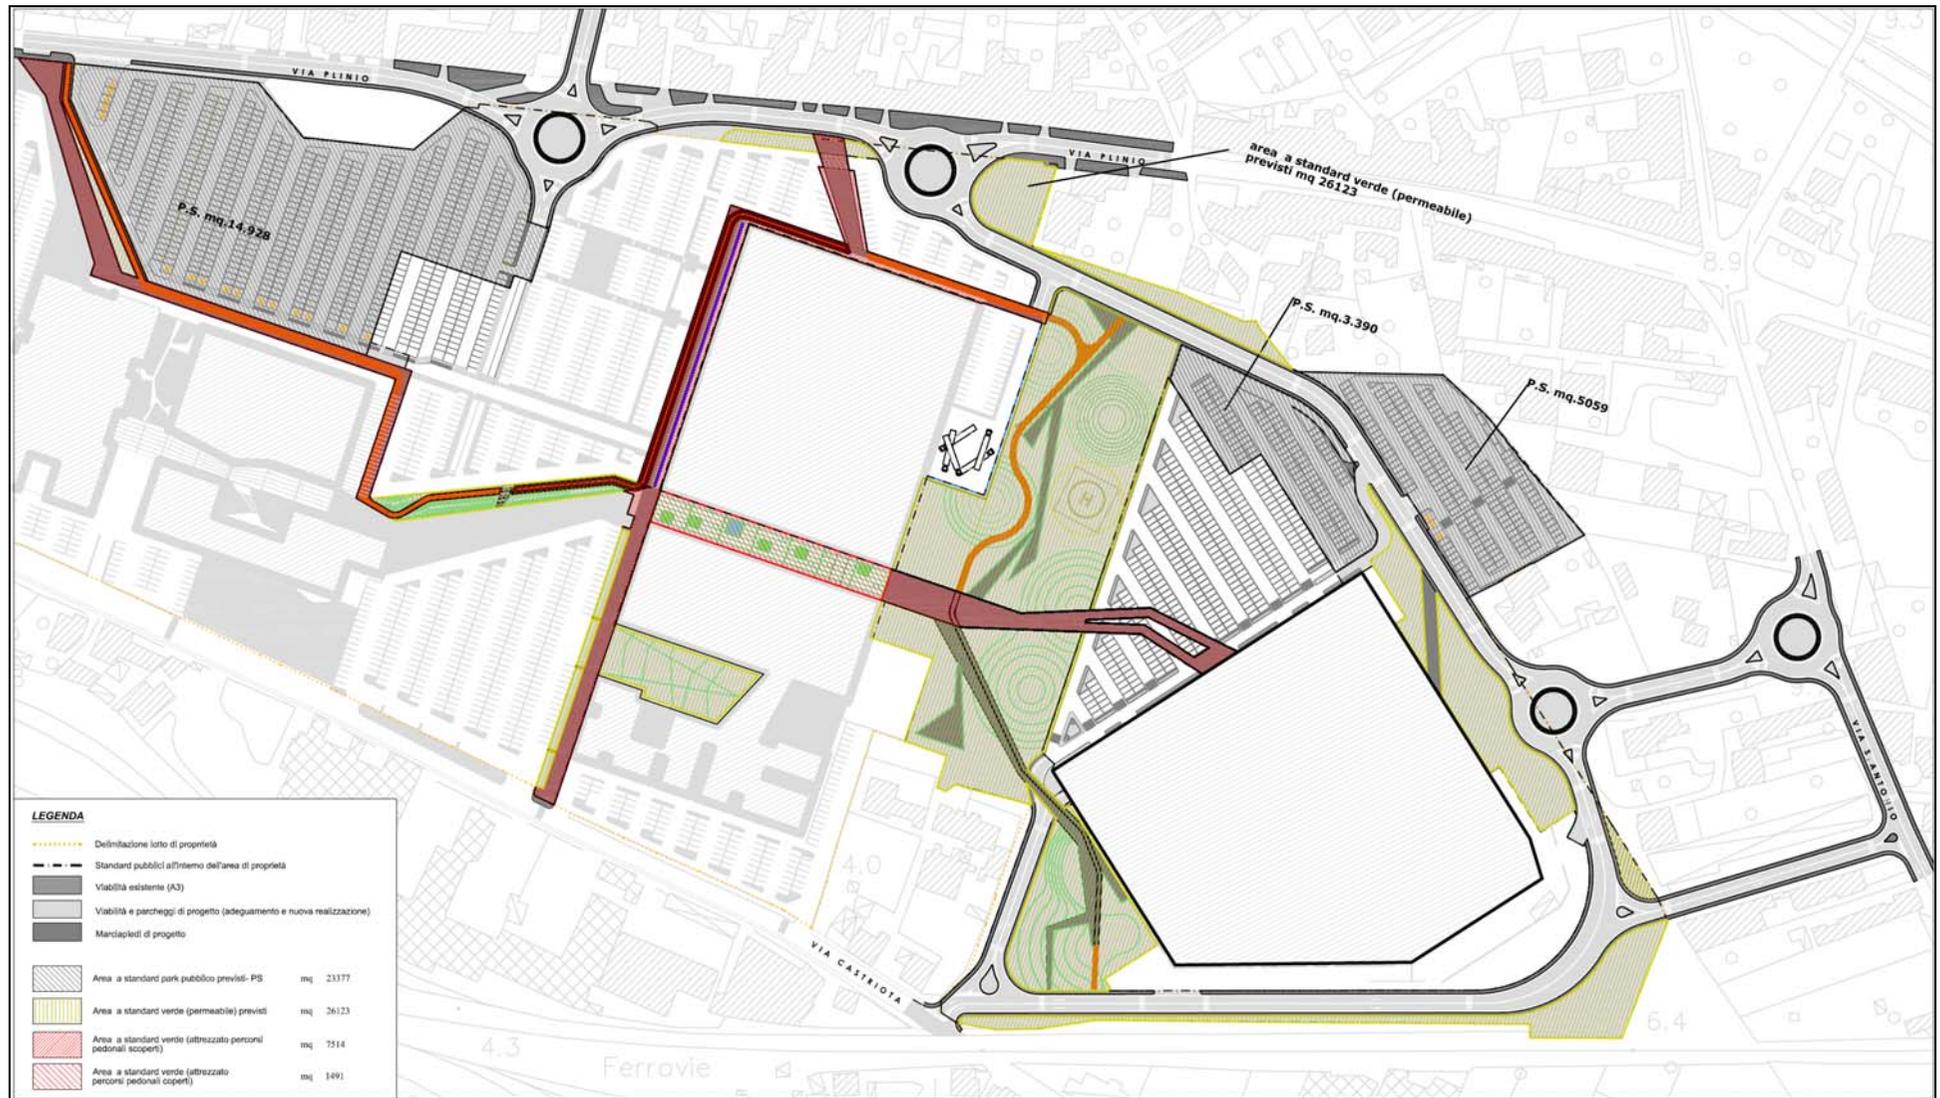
Planimetria interventi di progetto con individuazione standard pubblici coma da variante urbanistica prevista dall'A.d.P (Stralcio elaborato VdTpm.016)
